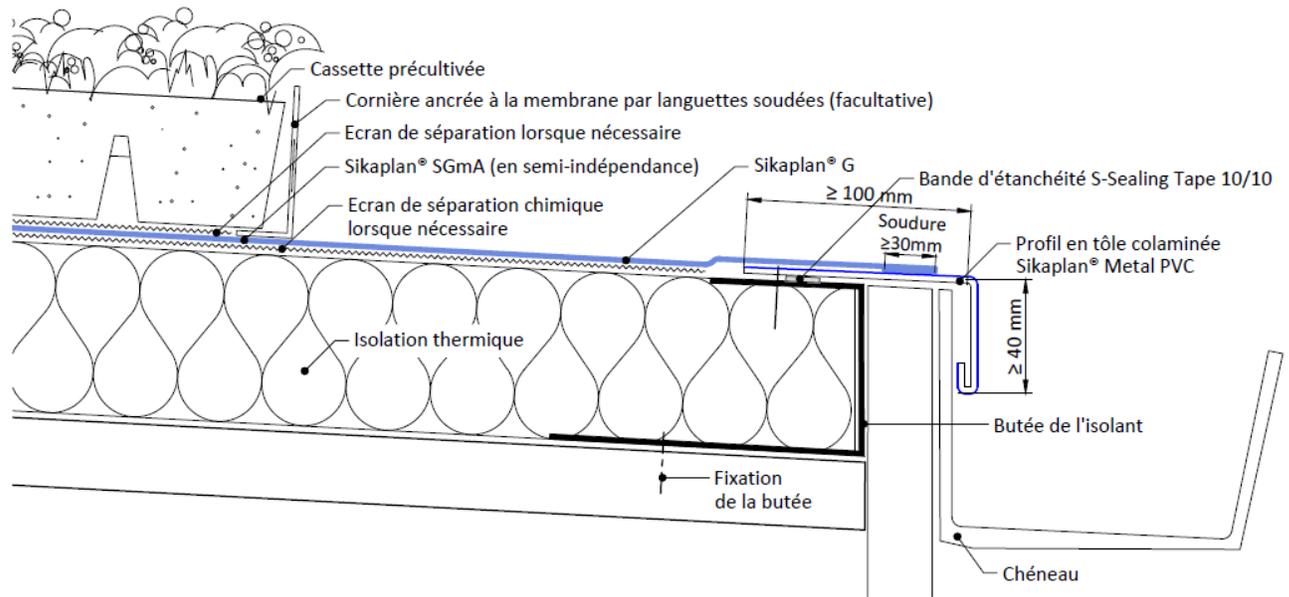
Rive en retombée avec profil en tôle colaminée Sikaplan® Metal PVC
